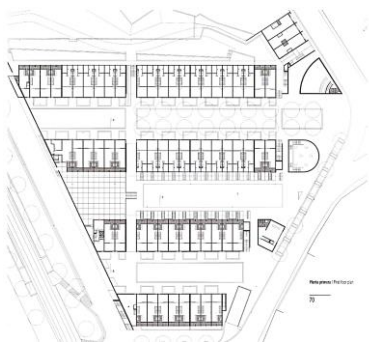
Planta geral do Bairro da Bouça, SAAL, Porto, 1976-2006. Do arquitecto Siza Vieira
